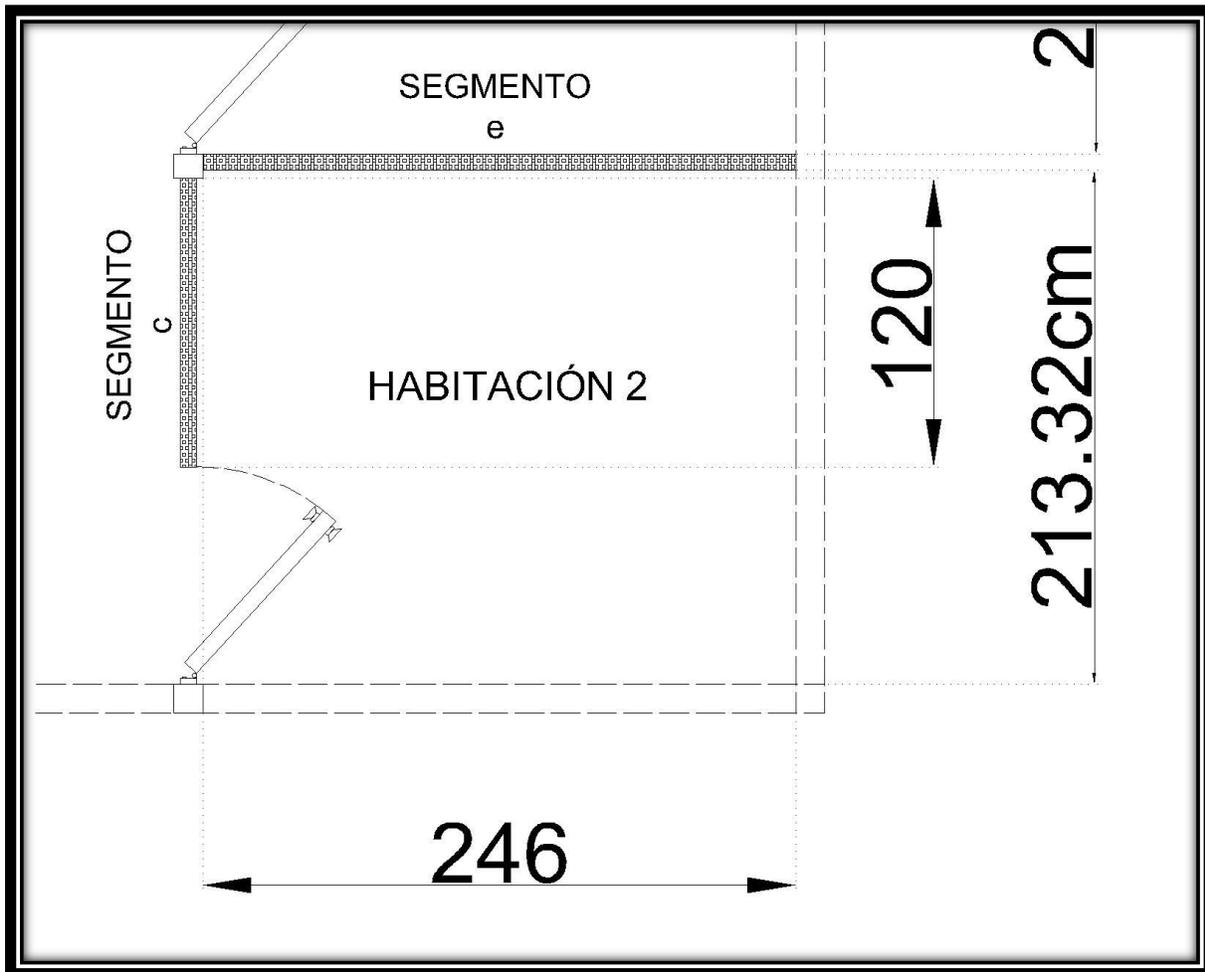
Muros con Paneles de Yeso. Detalle Habitación 2.
